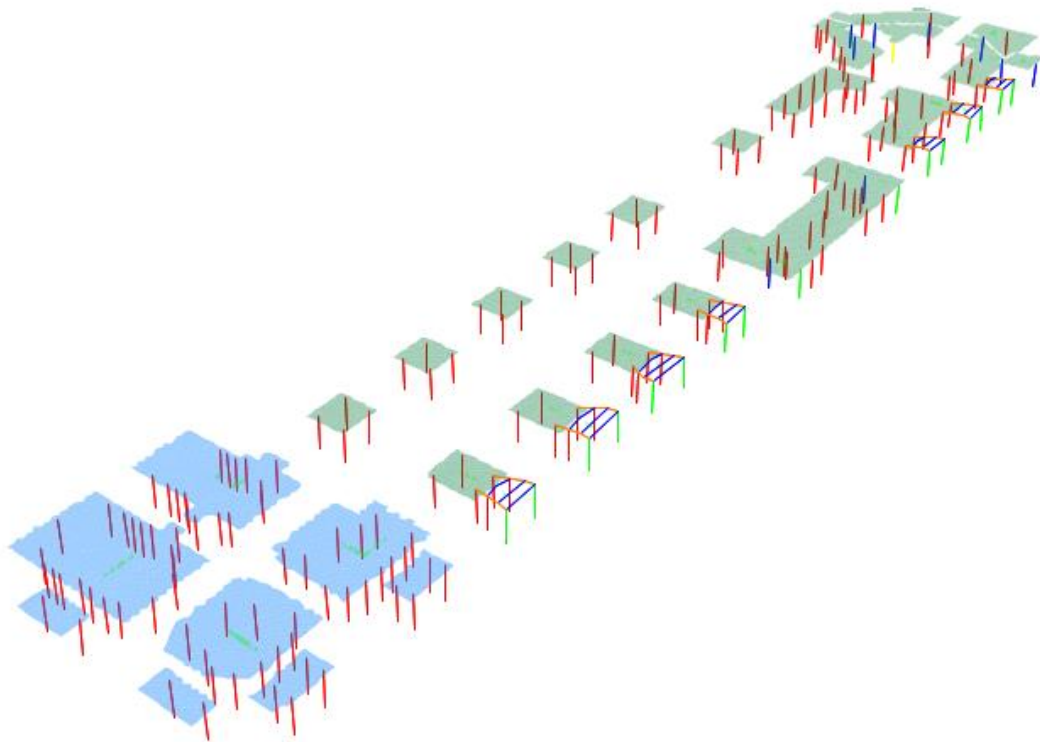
Vista de la planta modificada del modelo estructural para el análisis de la Fase A de Excavación.
